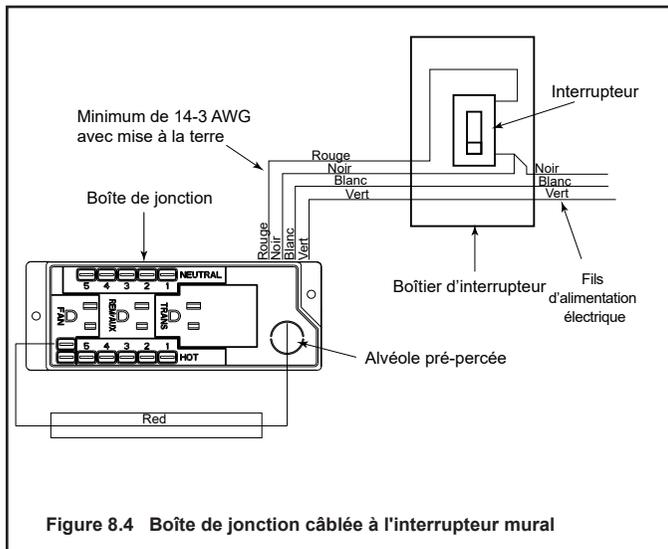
Boîte de jonction câblée à l'interrupteur mural
